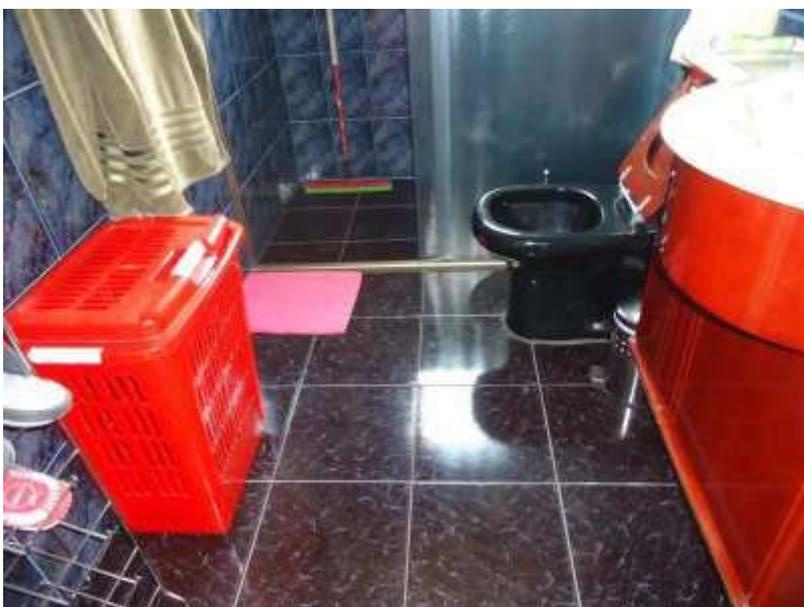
Detalhe interno da edificação – Pav. Térreo – Banho-Suíte
